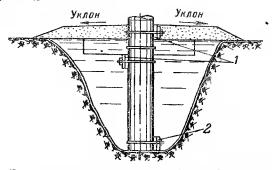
Нижняя часть железобетонной опоры с верхними и нижними ригелями.
